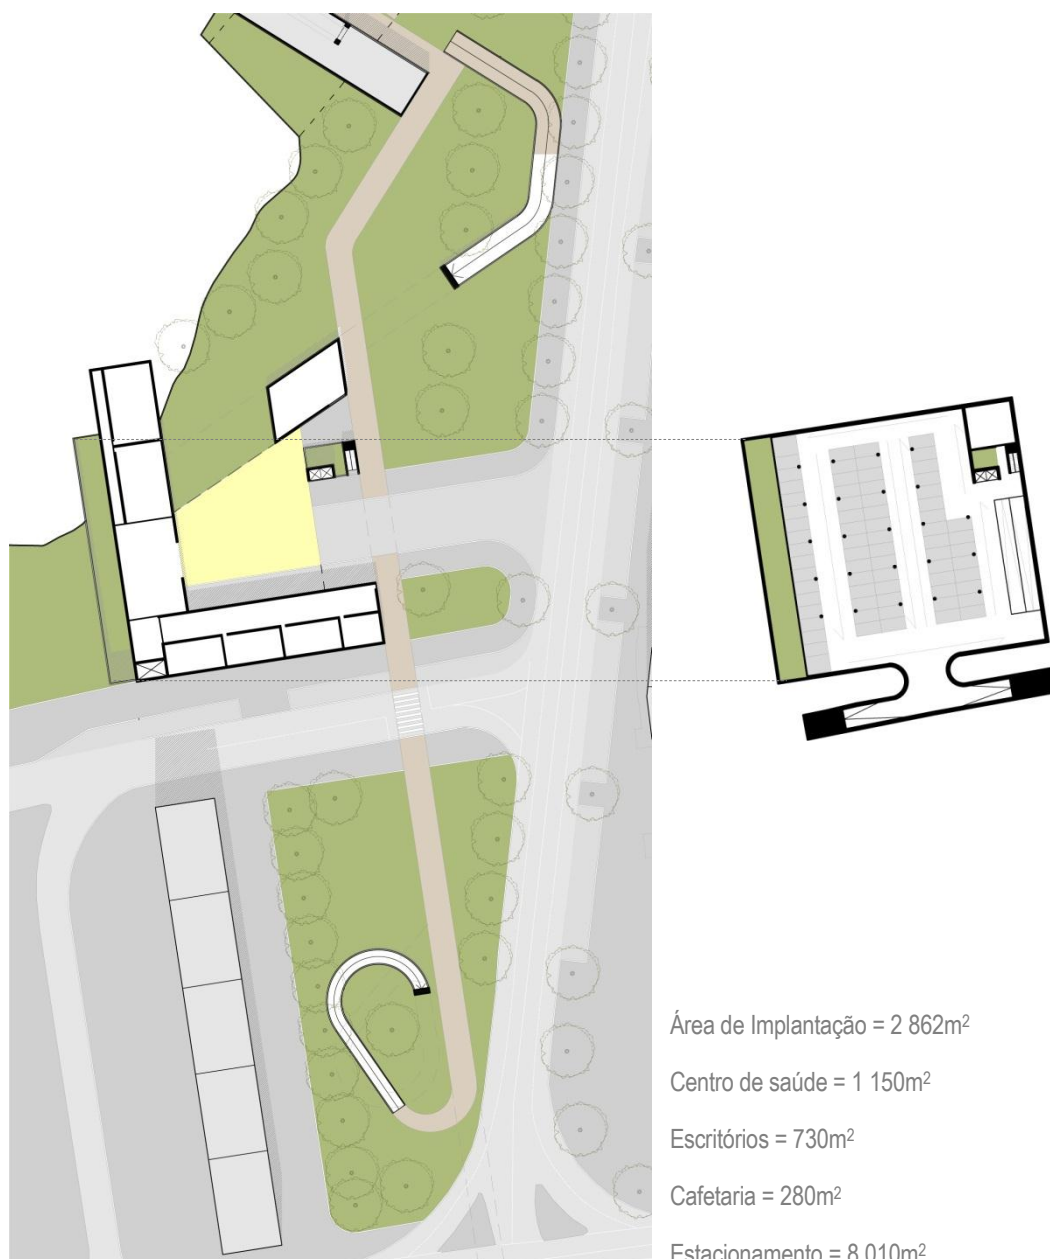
43 – Planta Têrrea e do Estacionamento do Centro de Saúde.
